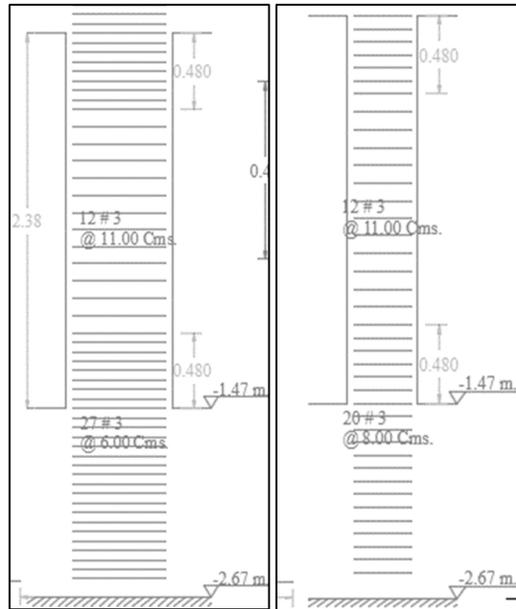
Despiece columnas SECCIÓN C1, SECCIÓN C3.
